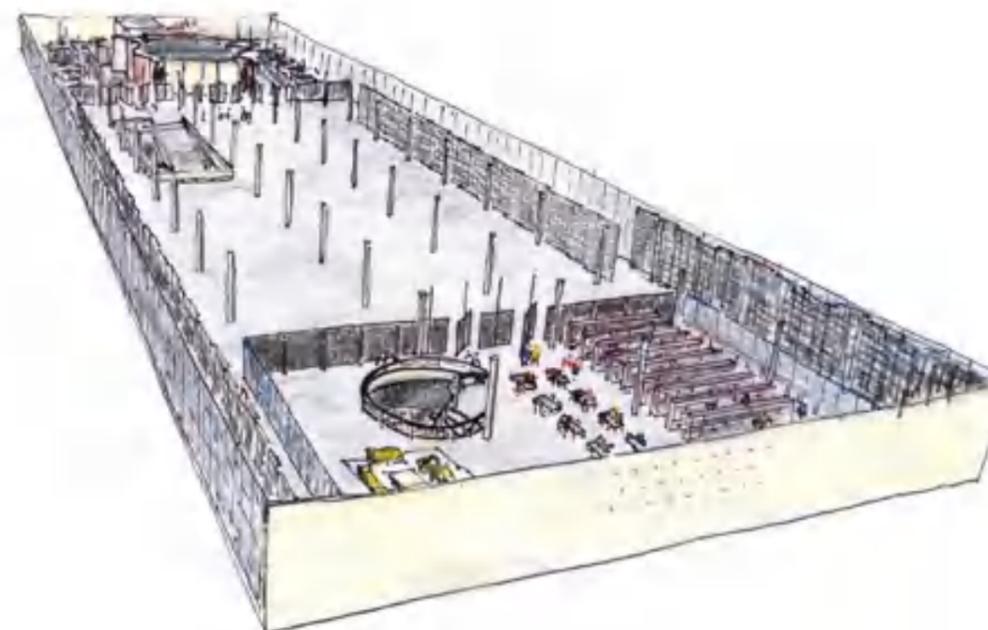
Croqui do Pavimento Superior. Fonte: Brasil Arquitetura.
